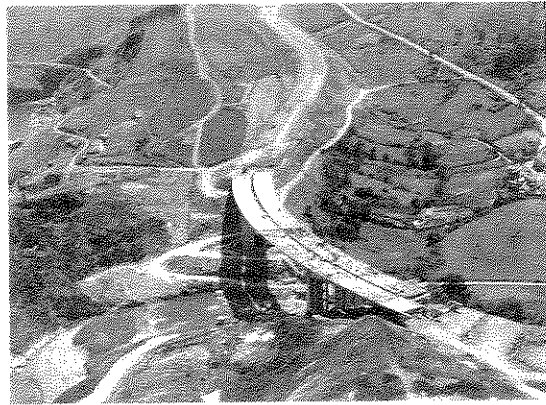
Puente de Ontón. En fase avanzada de construcción.
